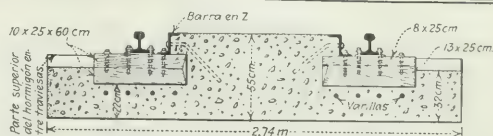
LECHO DE VÍA DE HORMIGÓN
